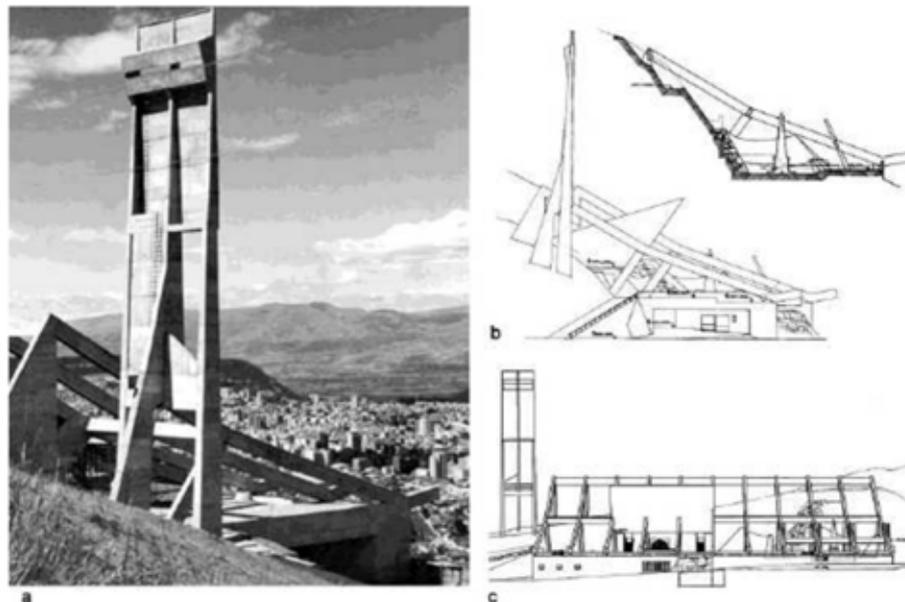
Templo de la Patria a) Vista del edificio y Quito b) Secciones transversales c) Alzado este hacia la ciudad⁷
